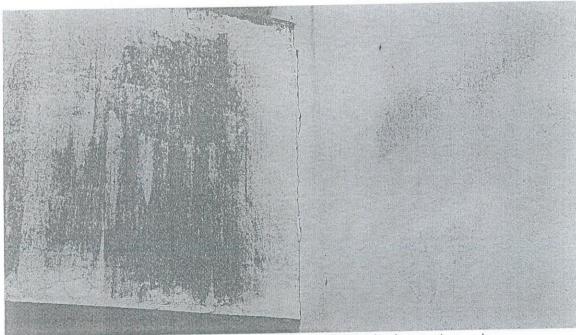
Fissura entre guarda corpo da escada e parede de apartamento
